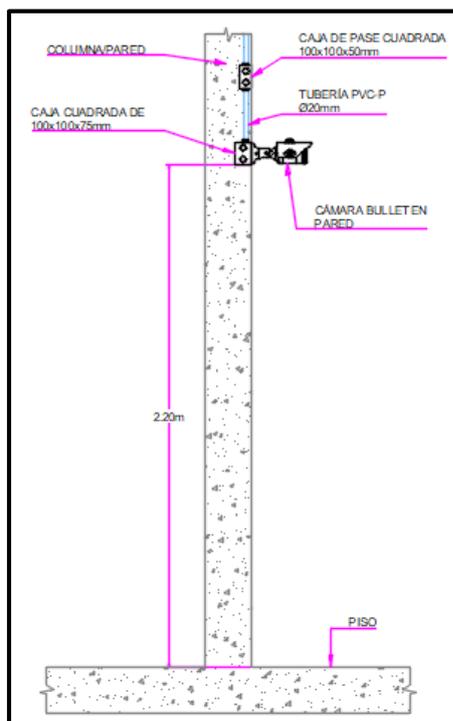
Ubicación Cámara tipo Bullet instalada en pared.
